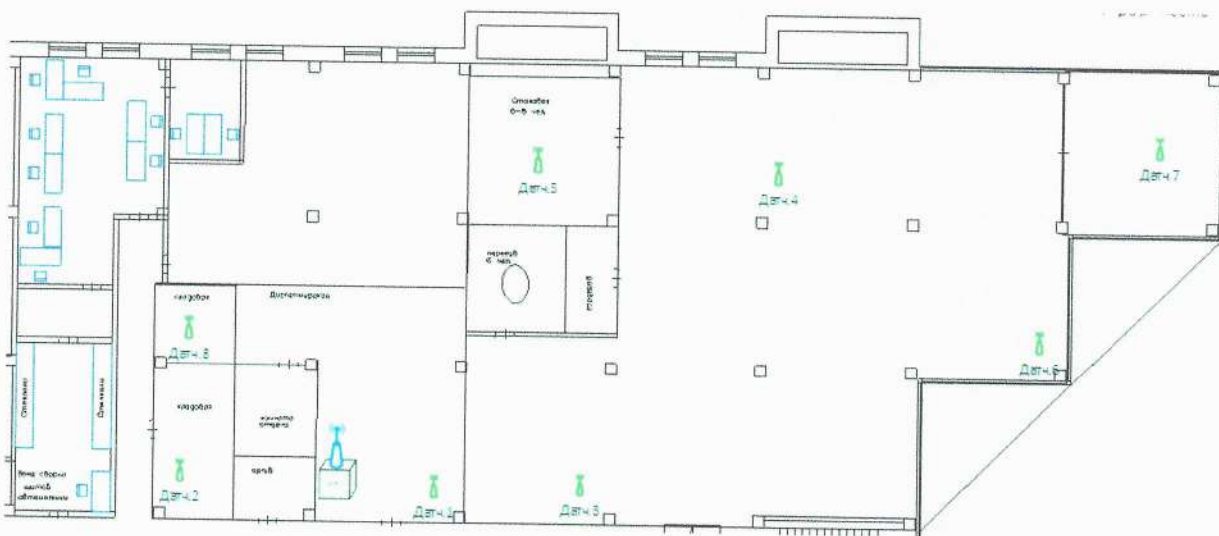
Фрагмент 2-го этажа корпуса 91. План размещения испытываемого оборудования.
